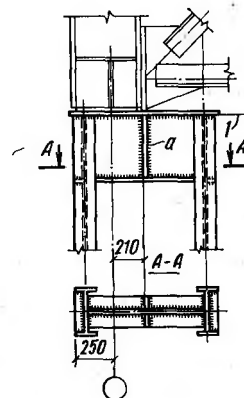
Оголовок колонны крайнего ряда бескранового здания
